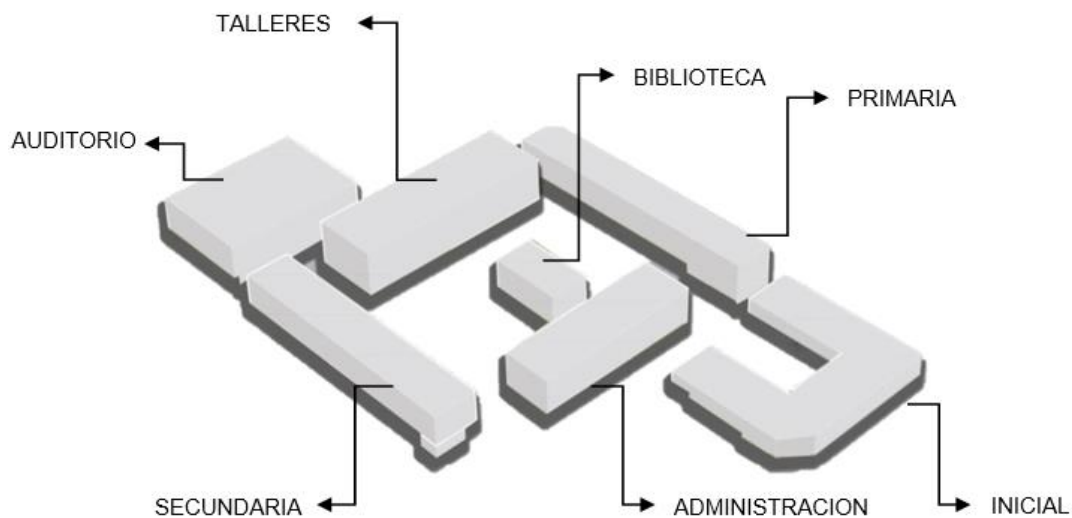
volumetría del proyecto, Fuente: Elaboración propia
